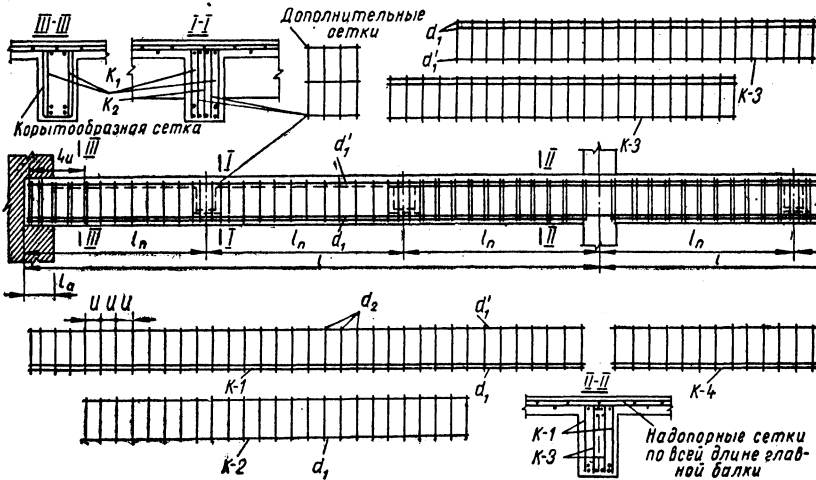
Армирование многопролетной главной балки плоскими сварными каркасами в пролете и на опоре.
